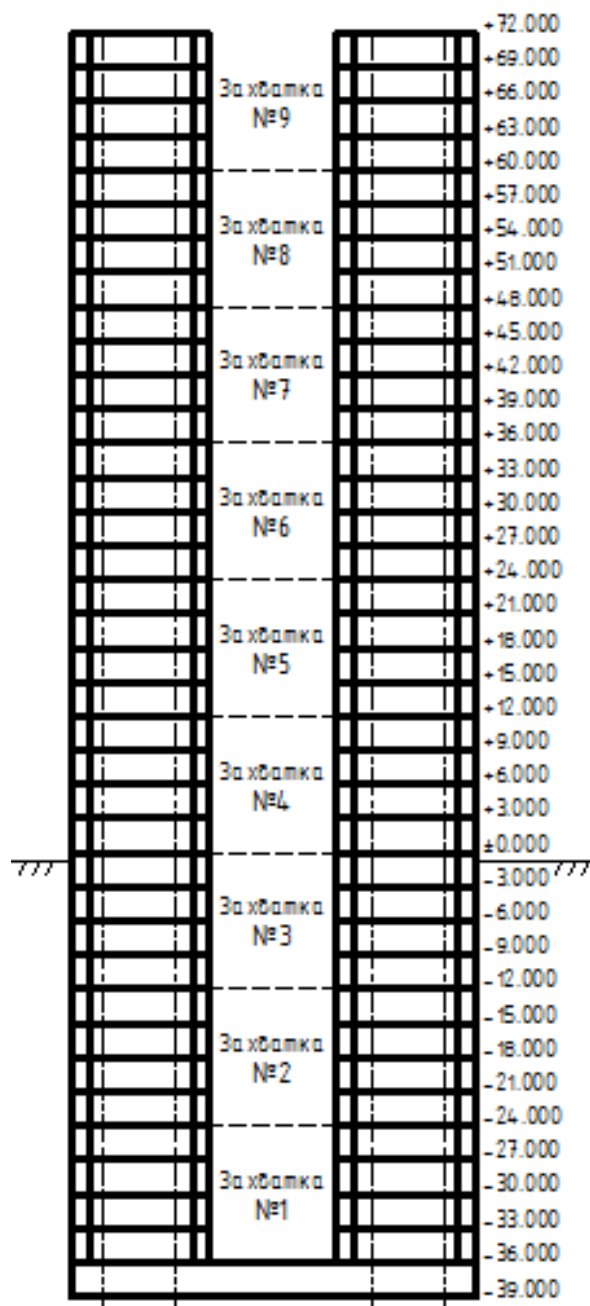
Схема разделения конструкций стен по захваткам.
